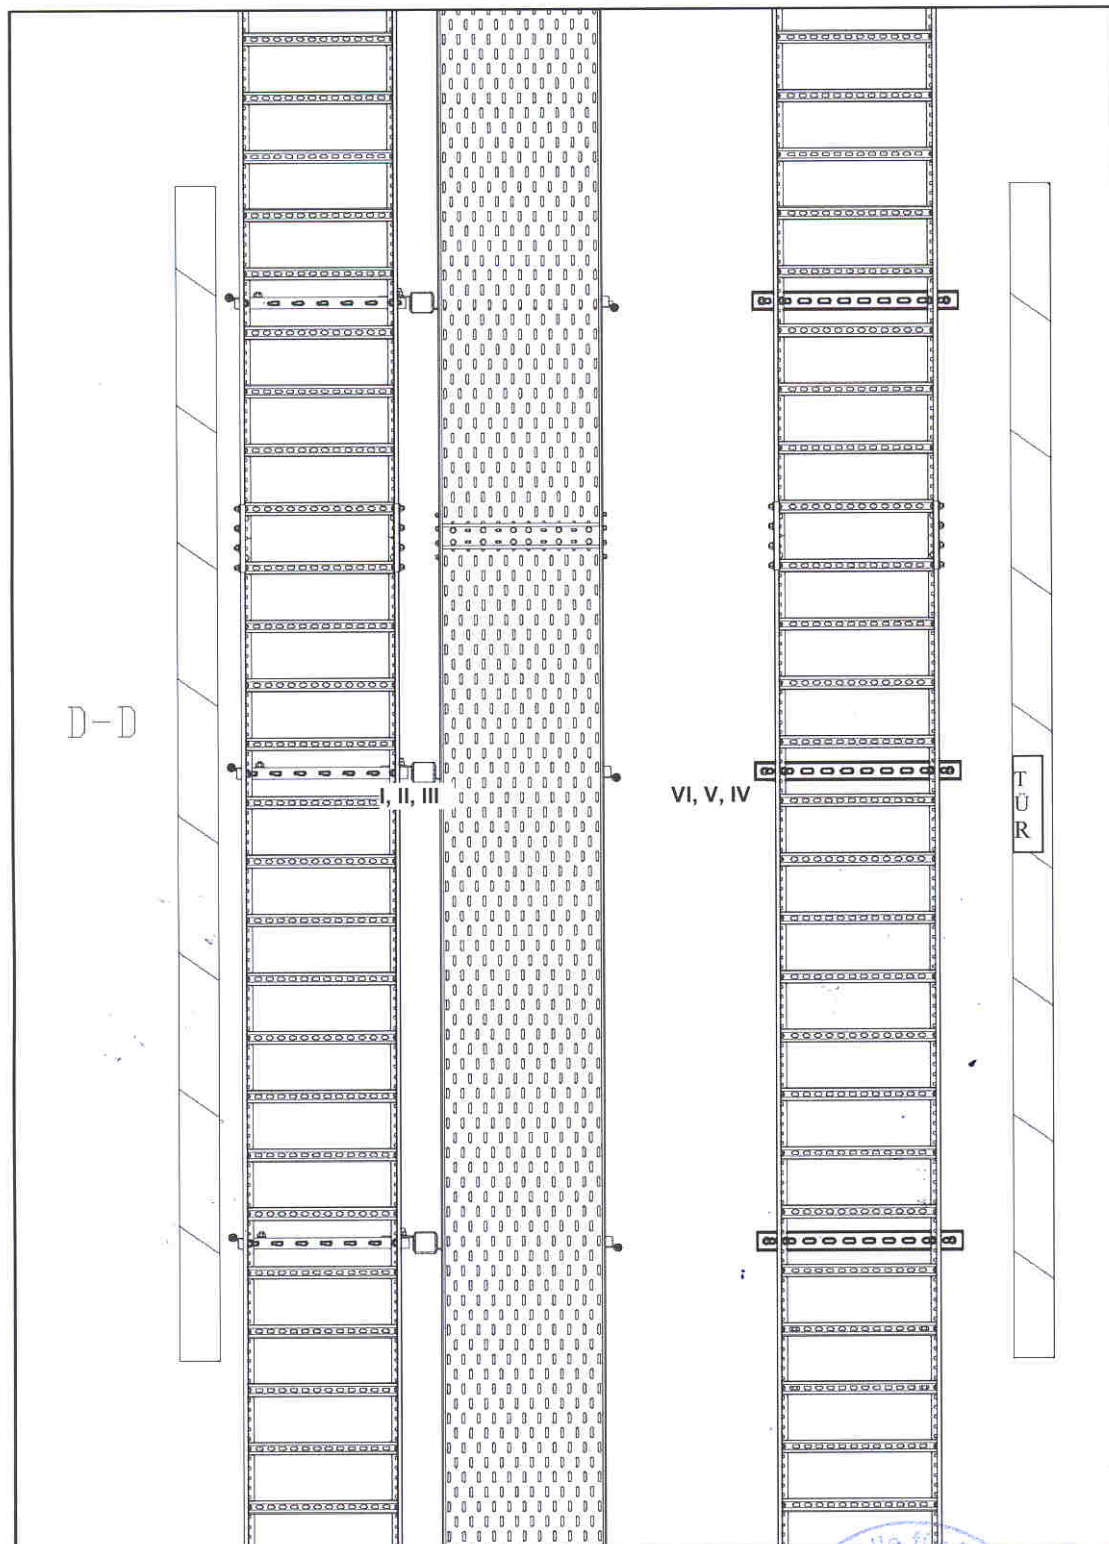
Lage der Thermoelemente im Grundriss
